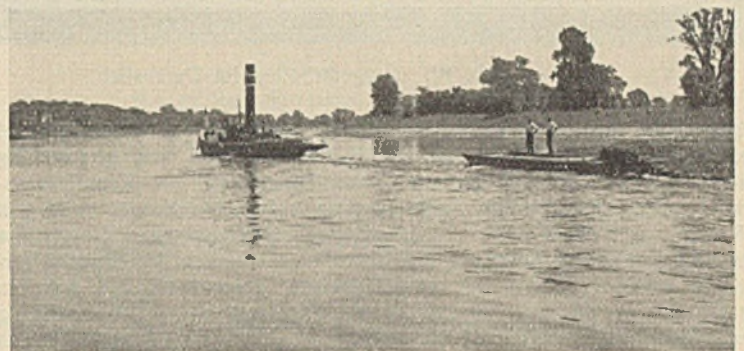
Schleppen eines Sinkstückes gegen den Strom.
